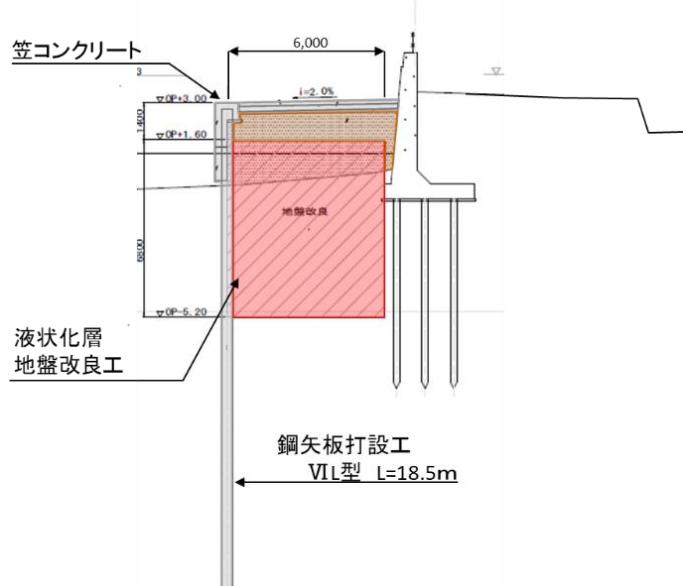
防潮堤耐震補強の標準断面（一級河川六軒家川）
